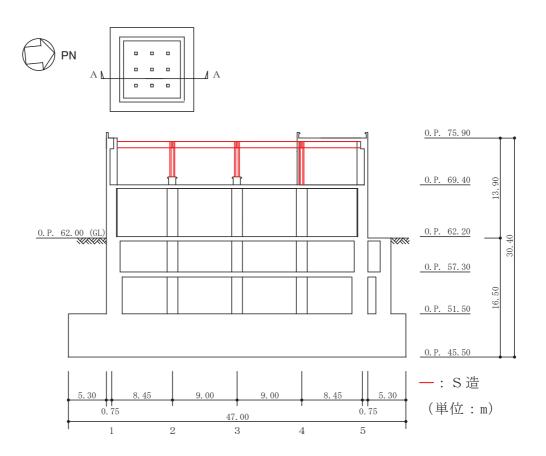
(1) 緊急時対策建屋の概略断面図 (A-A 断面, NS 方向)
